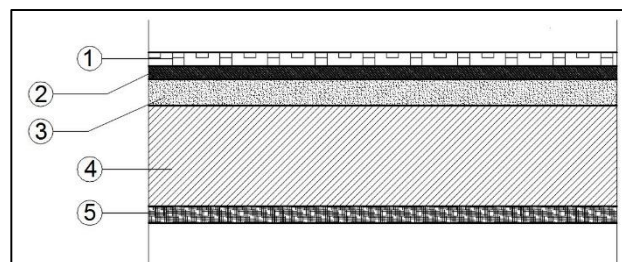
coupe sur (porte à faux) Dalles pleines étages courants.
